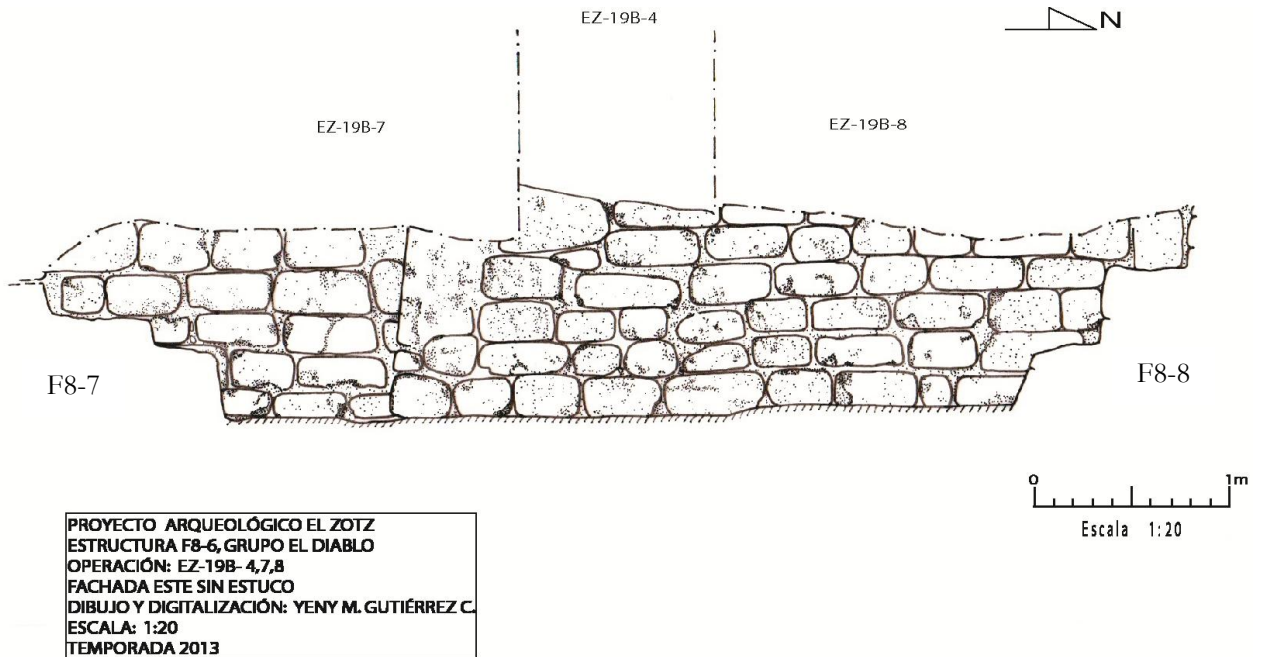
Dibujo de la fachada este de F8-6, sin estuco. Se muestra el acceso lateral de las escalinatas de F8-7 al sur y F8-8 al Norte.
